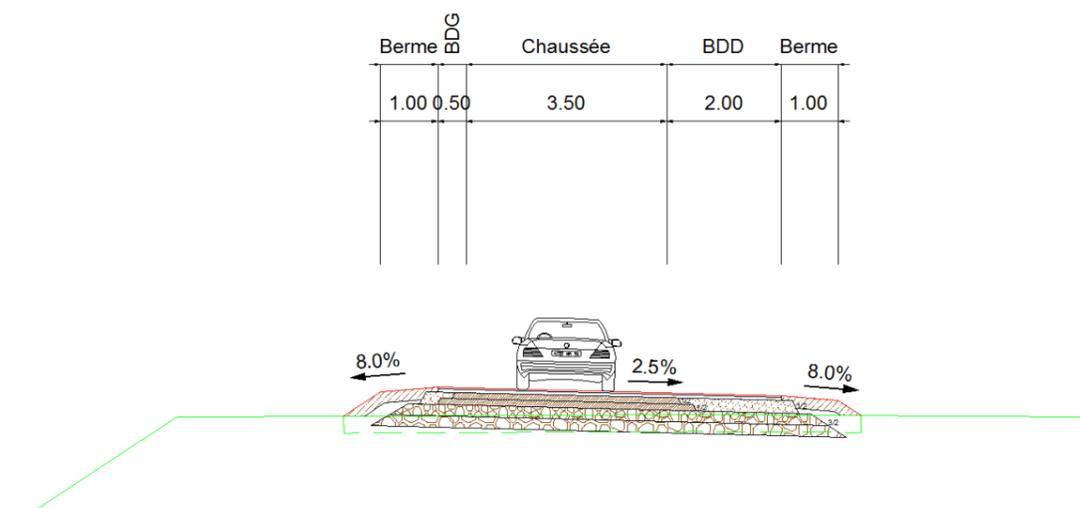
Profils en travers des bretelles de l'échangeur avec la RD 366 (source ARCADIS)
